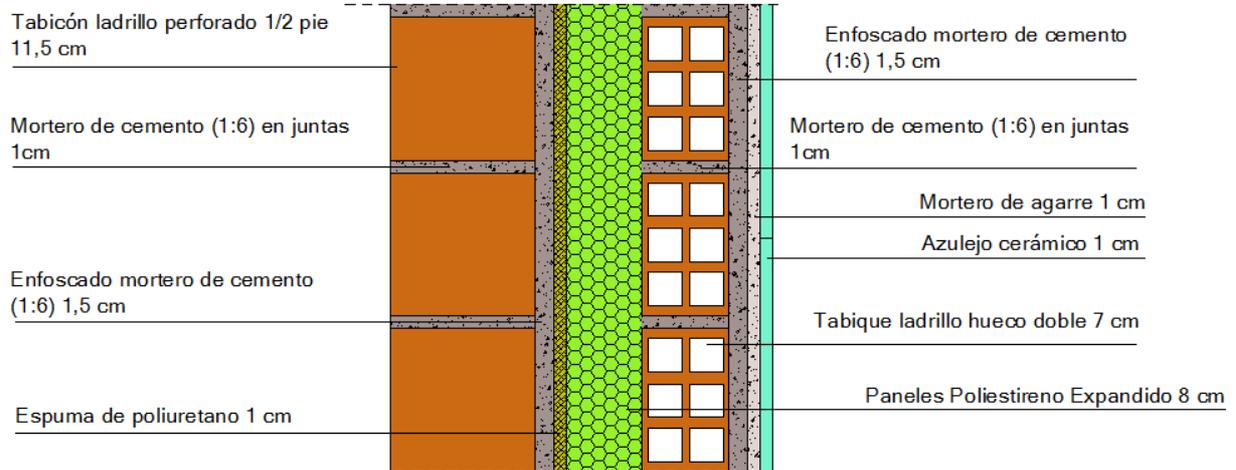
Detalle fachada tipo 2 propuesta.2014. CAD.
